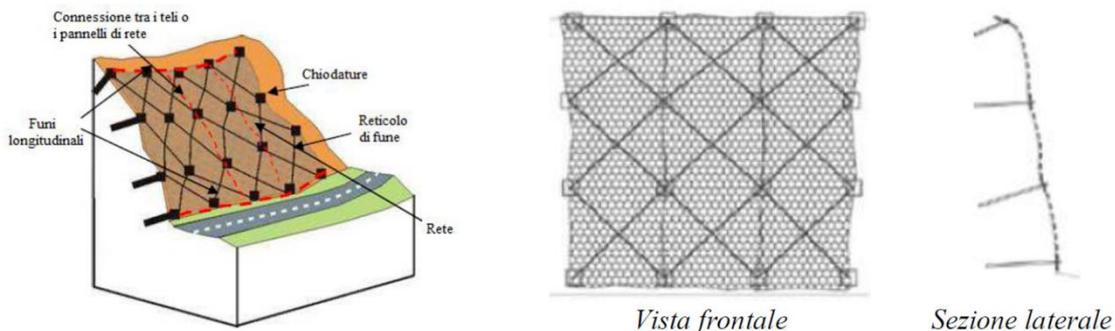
Schema generale, vista frontale ed in sezione di un intervento con Rafforzamenti corticali.
